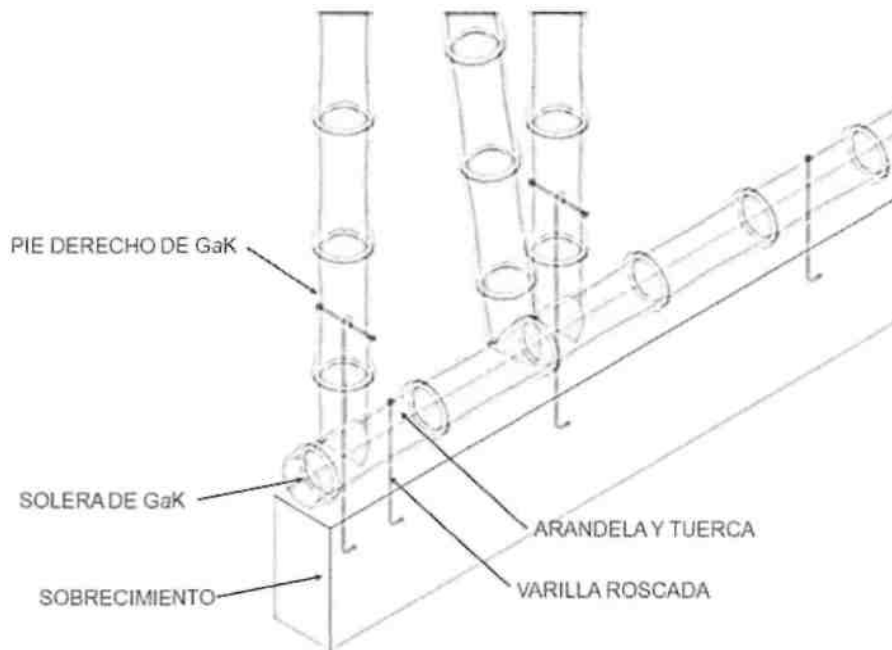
Detalle uniones en panel con estructura de culmos de GaK.
